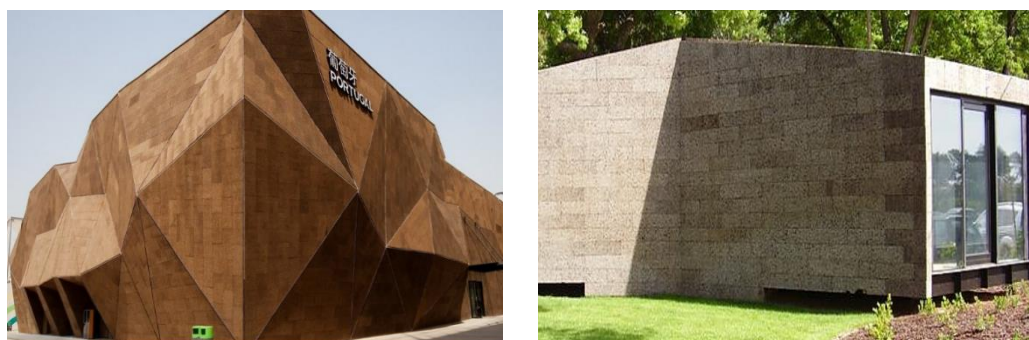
Aplicação da cortiça como isolamento de fachadas pelo exterior [20]
